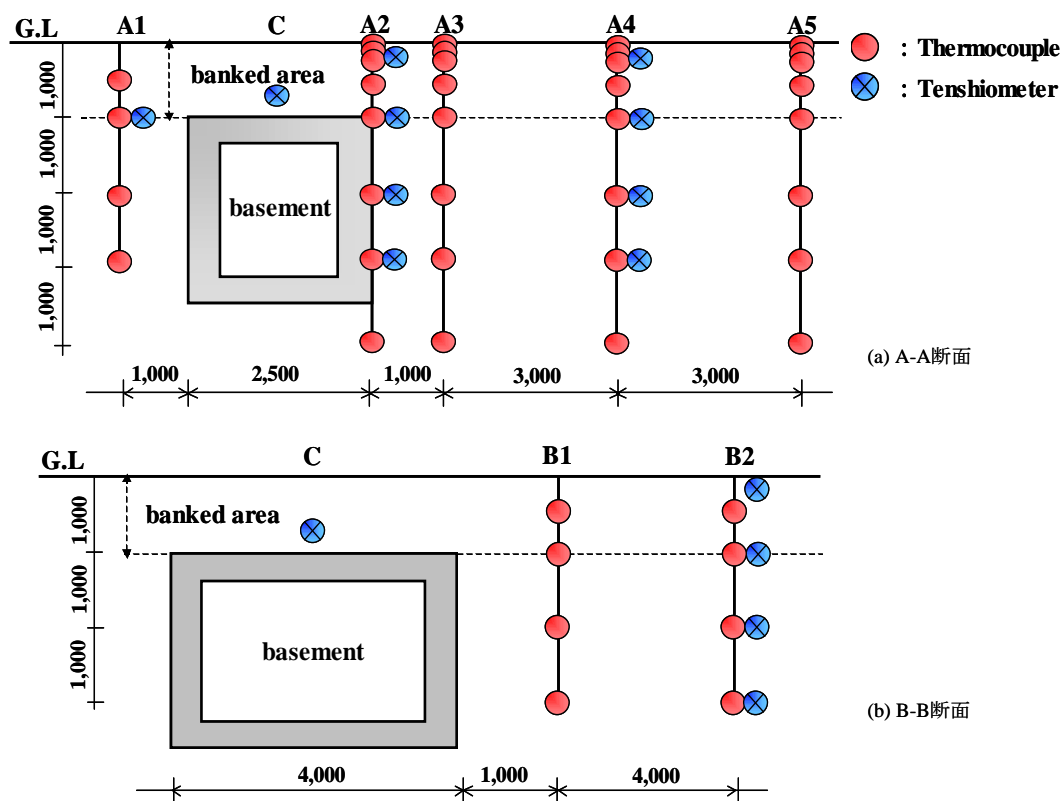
地下室周辺地盤内の計測状況 (単位: mm)
